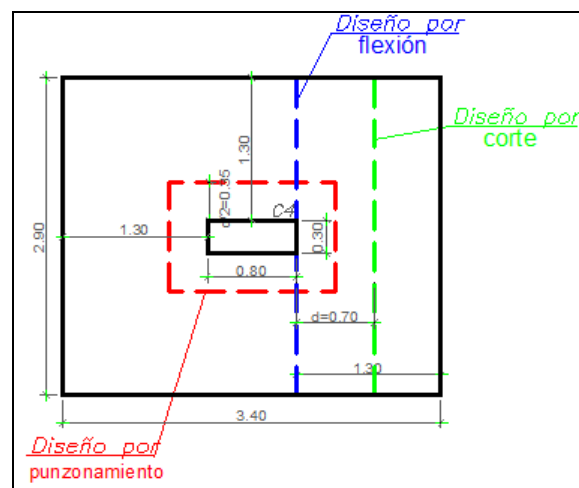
Secciones críticas para el diseño de una zapata aislada
